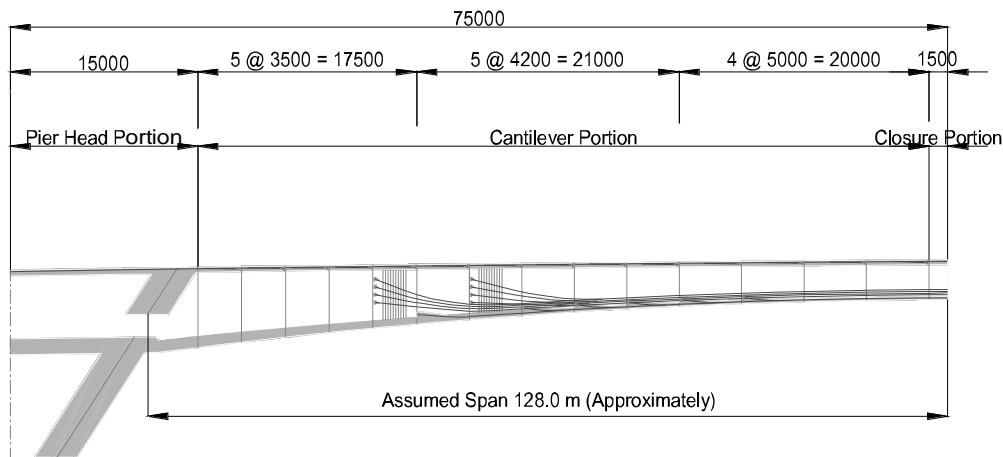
Các đốt tại chỗ trên giàn giáo
